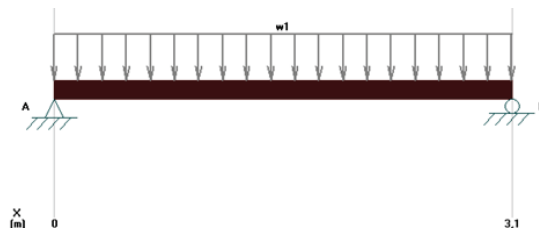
Viga simplemente apoyada (Fuente propia)
